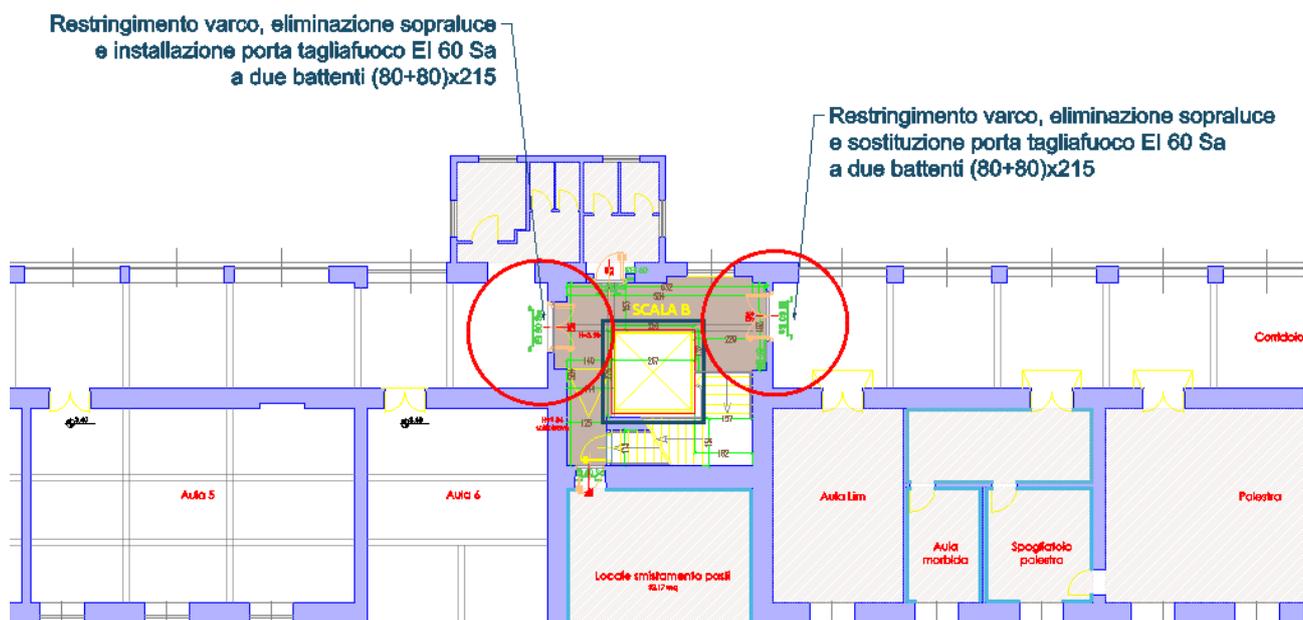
Dettaglio della localizzazione della chiusura con tamponatura dei soprauce al piano primo.
